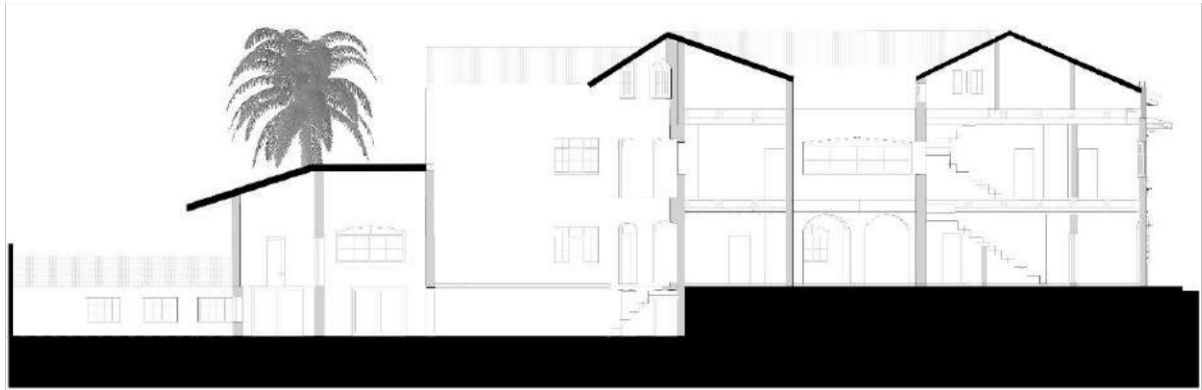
Sección de la Casa Cordero antes de la modificación // Fuente: (Surrealestudio, 2021)
